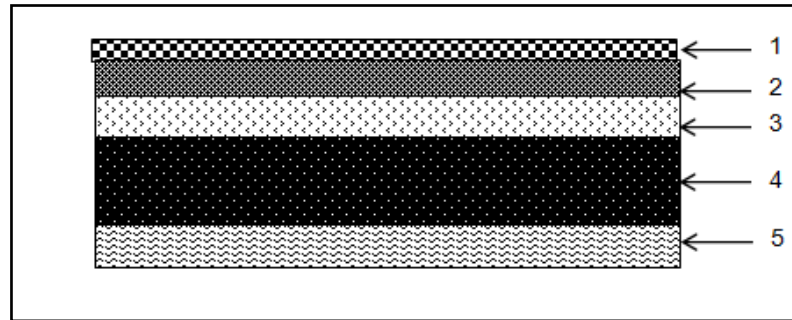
Coupe d'un plancher en dalle pleine.
